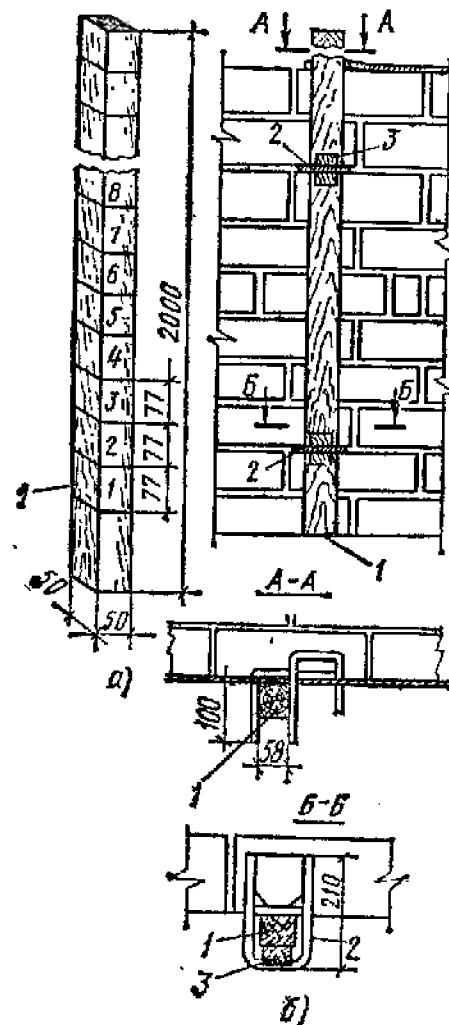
Инвентарная деревянная порядовка (а) и крепление порядовки к кладке (б):
